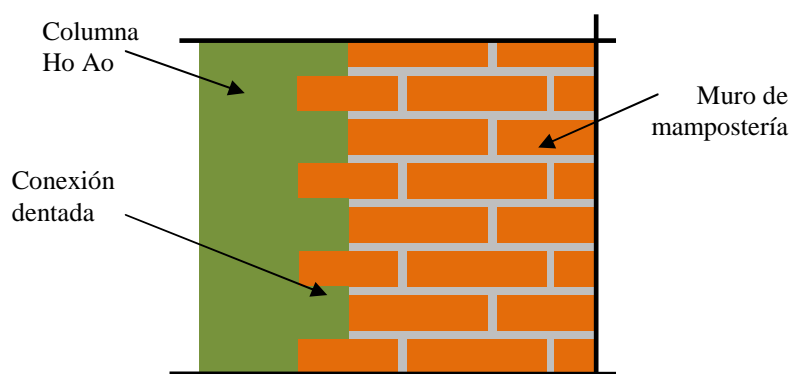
Interface dentada entre la columna y el muro de mampostería.
